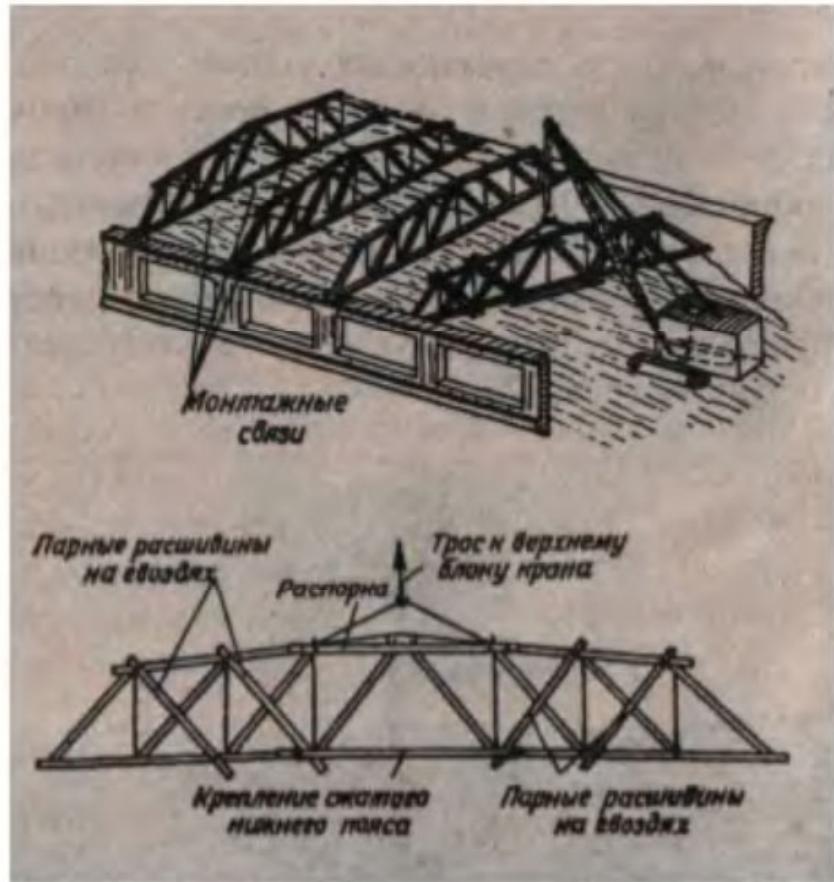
Подъем пятиугольной фермы на лобовых врубках краном на гусеничном ходу
